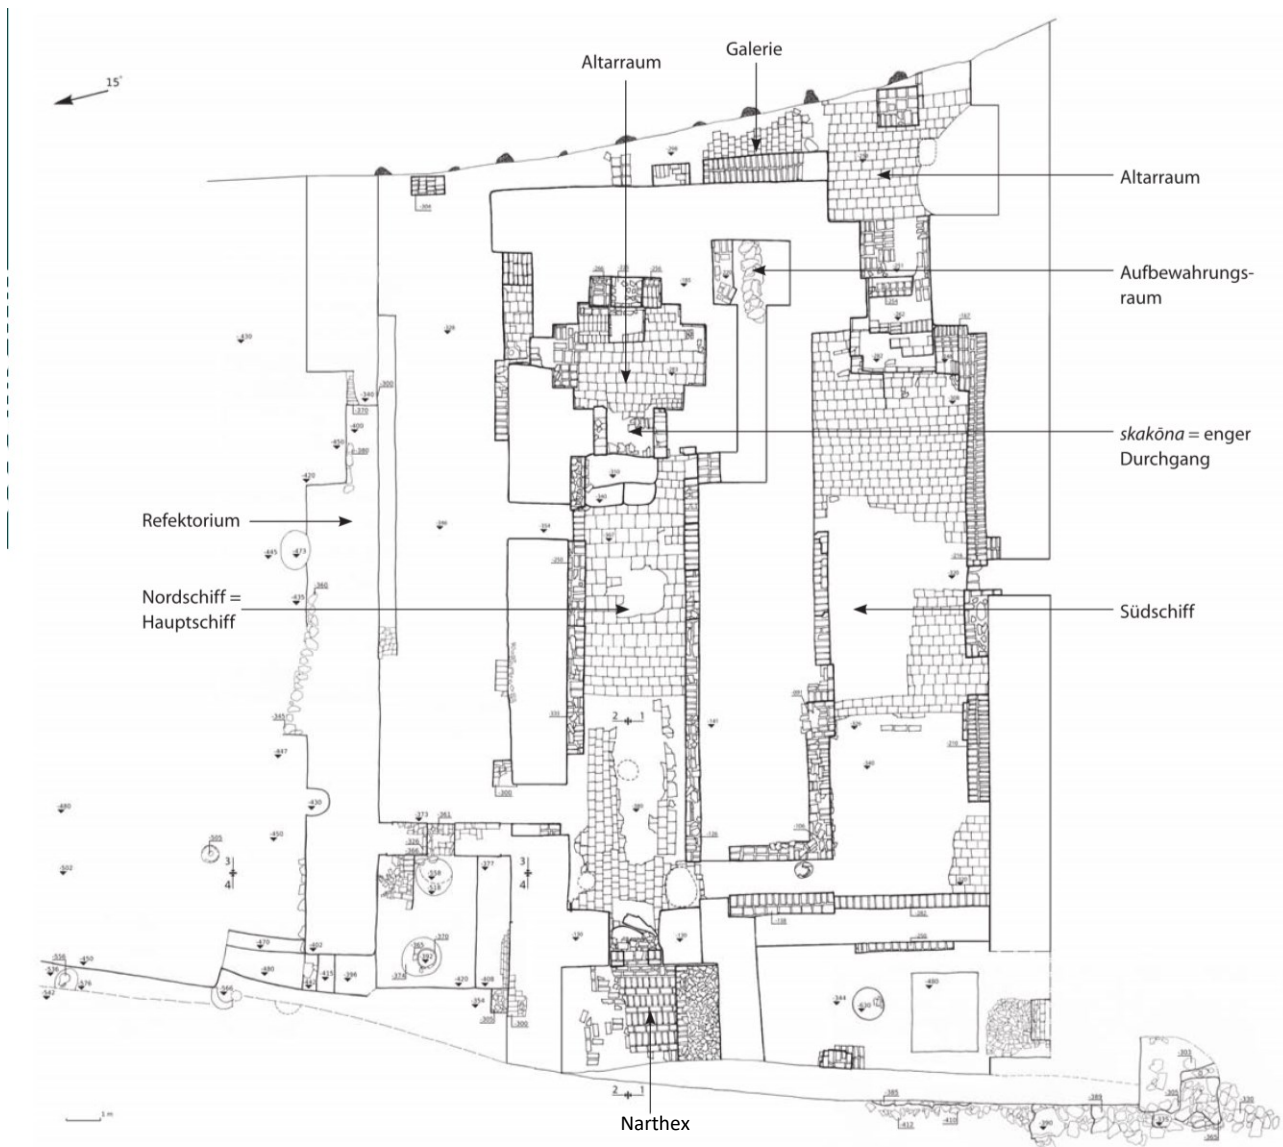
Grundriss der Doppelkirche des Klosters Urgut (Savchenko 2010, 78, Beschriftung des Narthex ergänzt).
